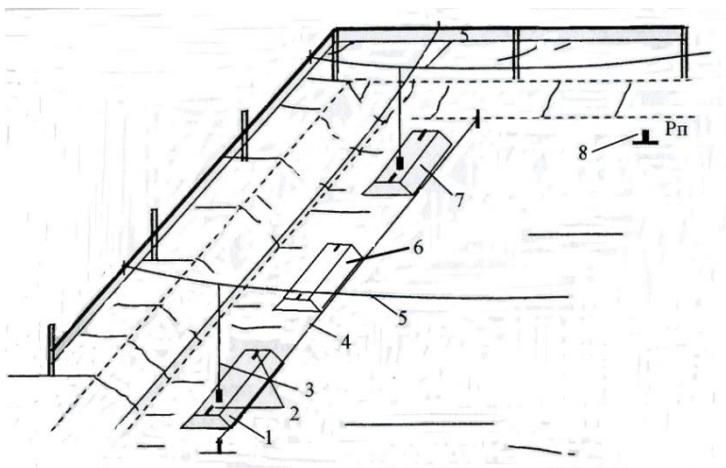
3. Монтаж блоков ленточного фундамента:
